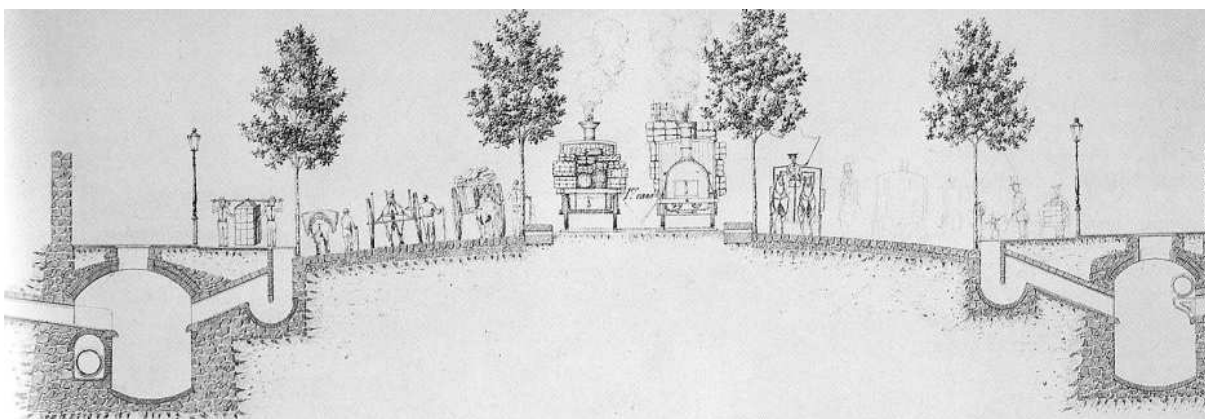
Perfil do pavimento e obras subterrâneas das ruas de Barcelona de acordo com o plano de Cerda.
